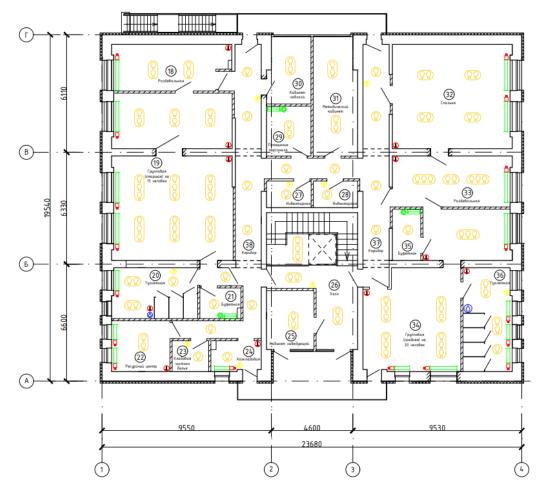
Вариант расстановки элементов беспроводной системы «Умное здание» на этаже 2
